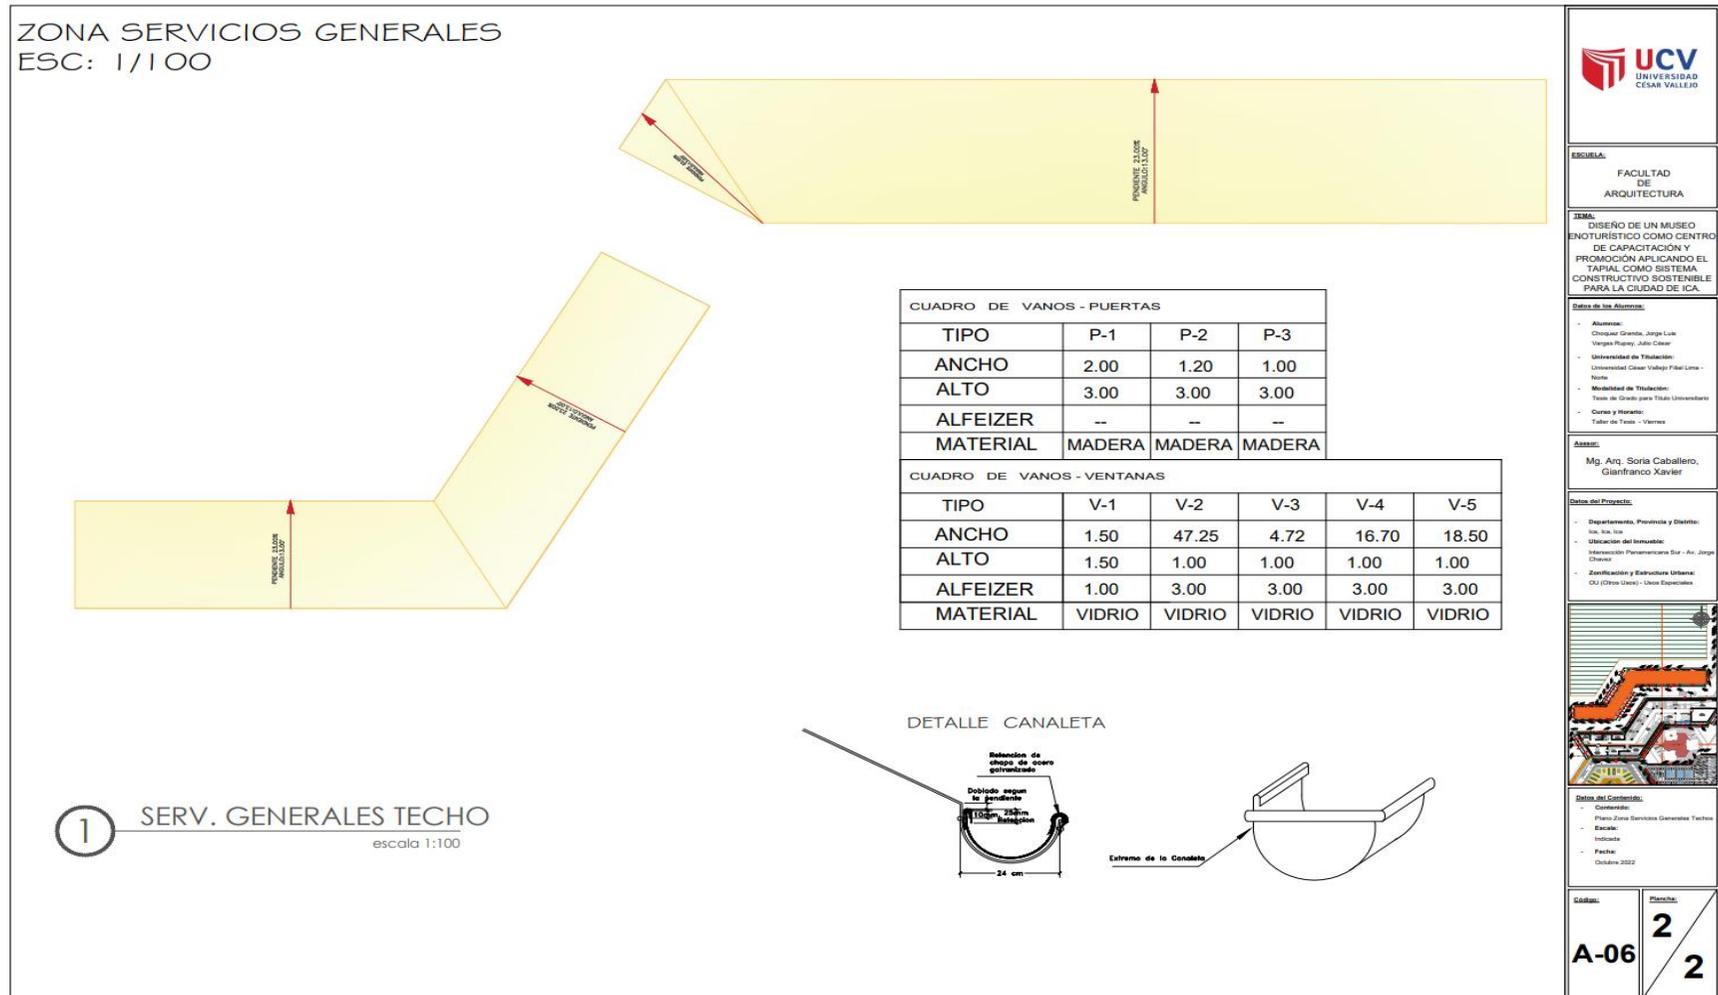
Plano Zona de Servicios Generales – Cortes y Elevaciones
